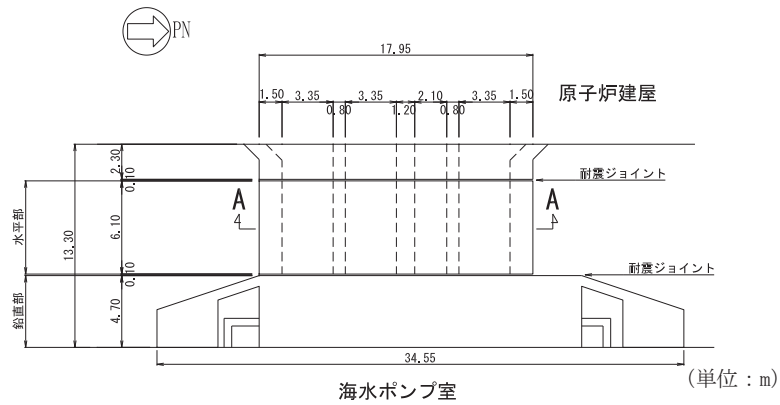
原子炉機器冷却海水配管ダクト（水平部）平面図
